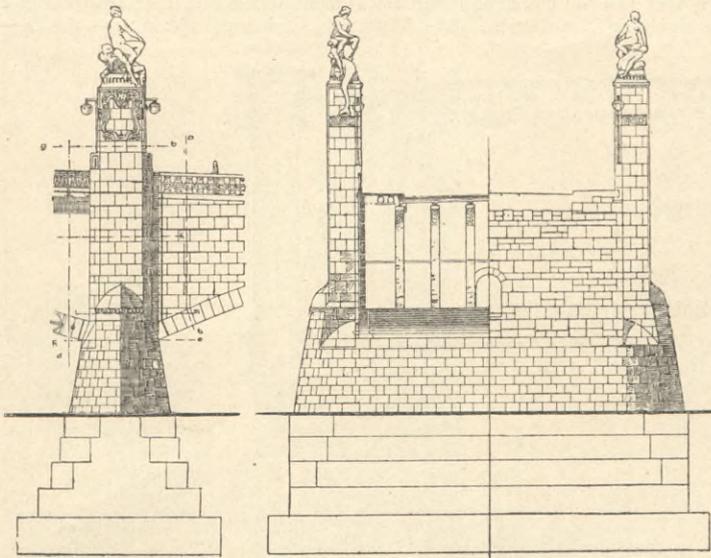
Strompfeiler. Längsansicht und Querschnitt mit Seitenansicht.
